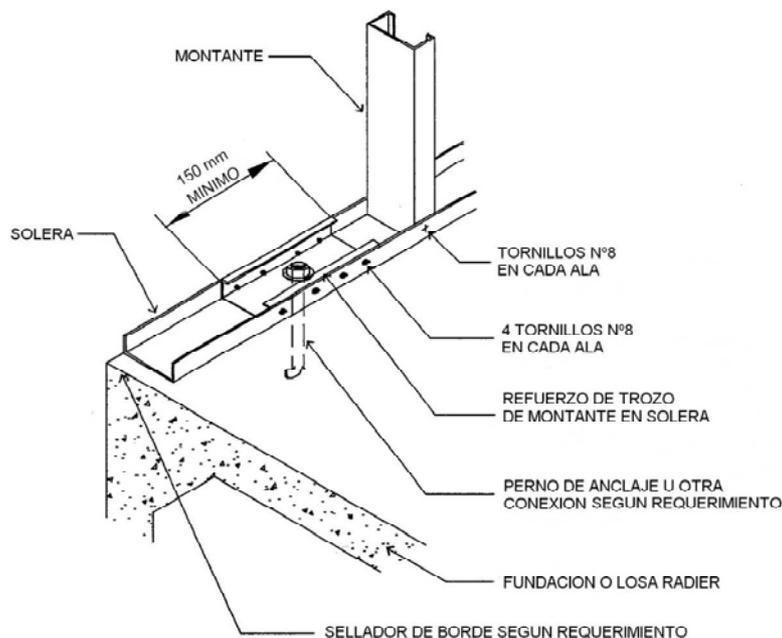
Detalle de anclaje de estructura a cimentación; Fuente: Manual de Steel Framing
